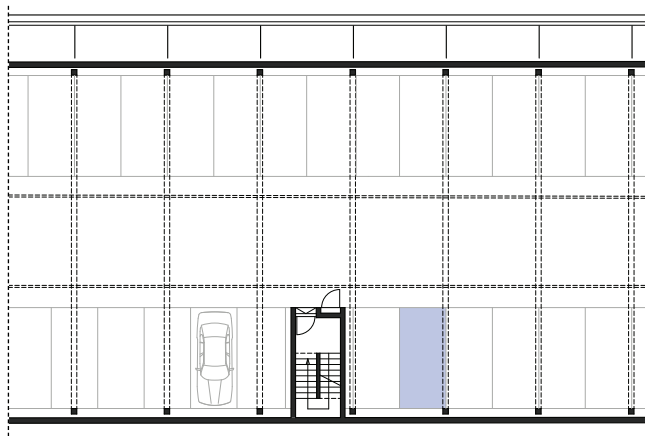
Grundrissausschnitt des Parkhauses am Bollwerksturm
